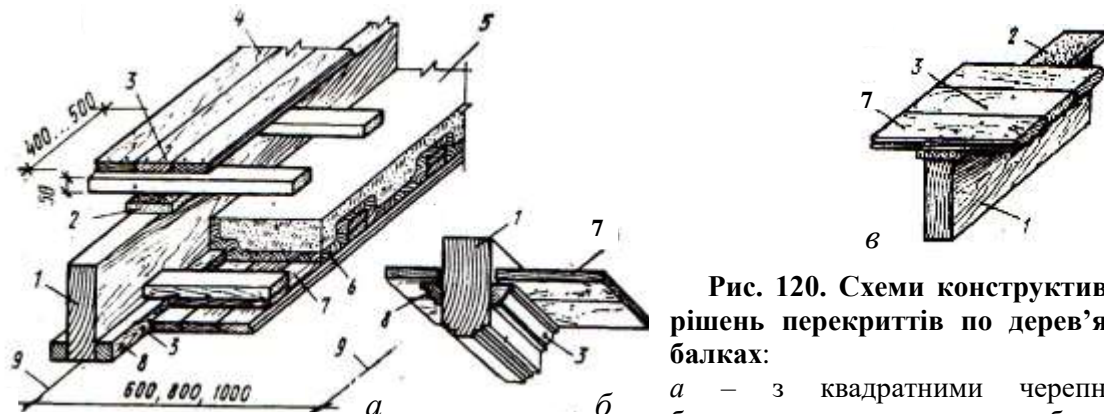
Схеми конструктивних рішень перекриттів по дерев'яних балках:
